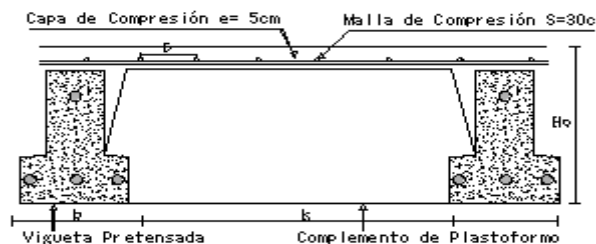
, Partes Constructivas de la Losa, Elaboración propia
